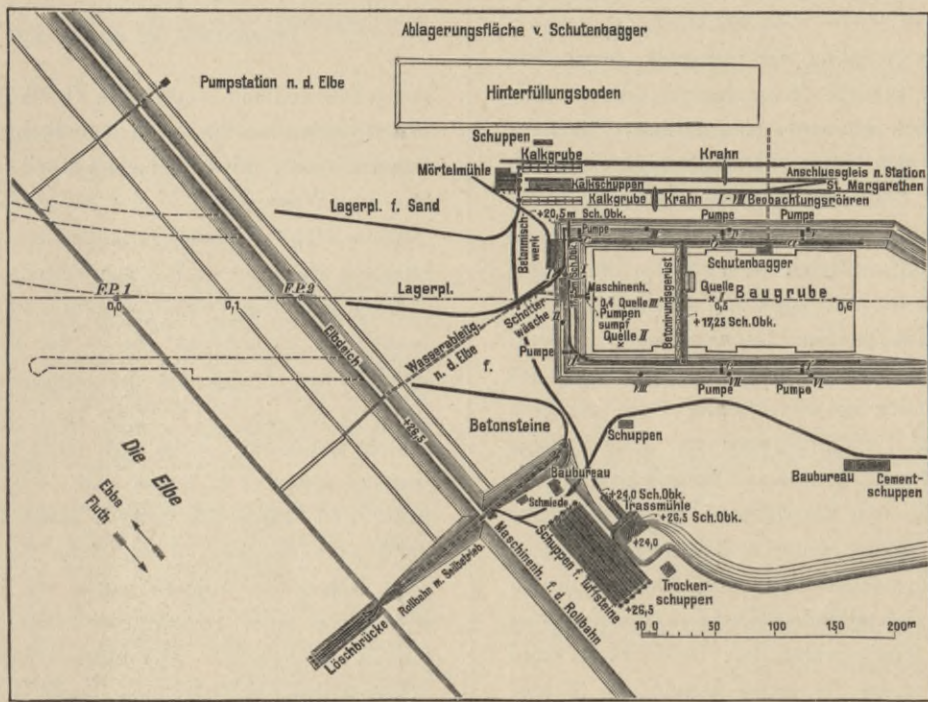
Lageplan der Schleusenbaustelle während der Betonirung. Sommer 1891.
